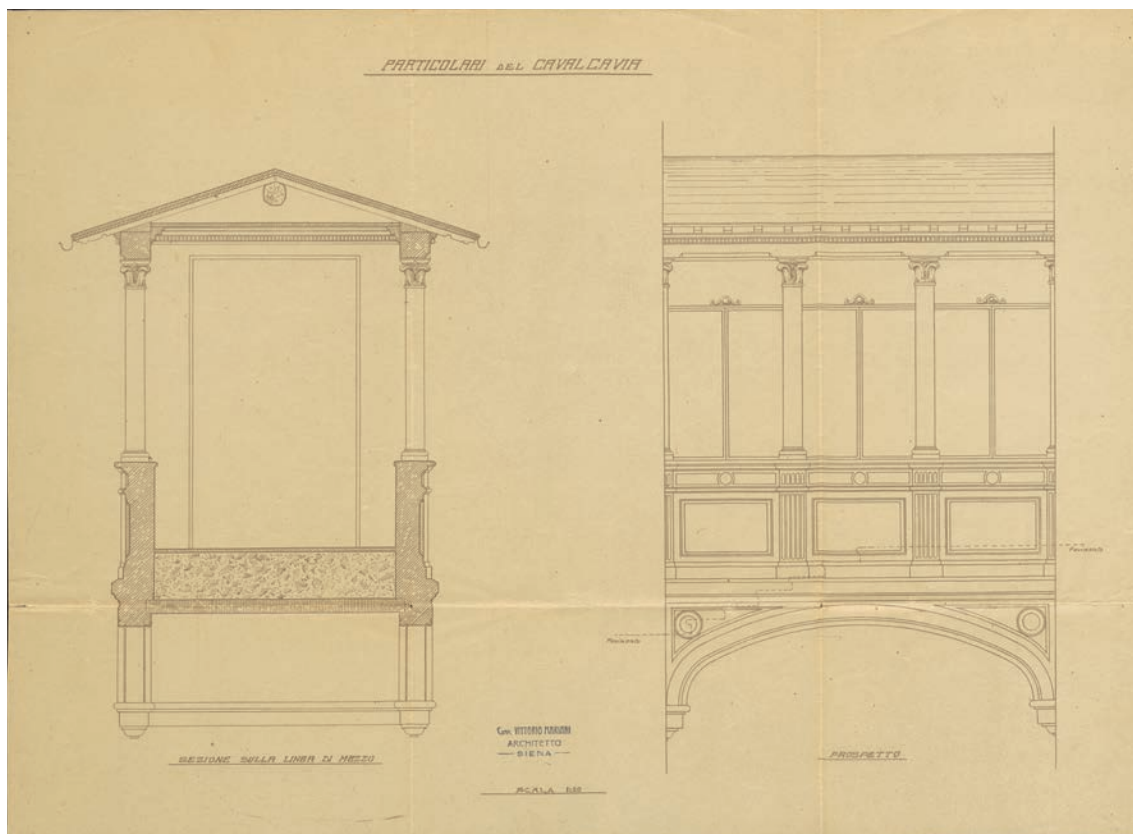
Prospetto e sezione del cavalcavia, Vittorio Mariani, ASCSi.
